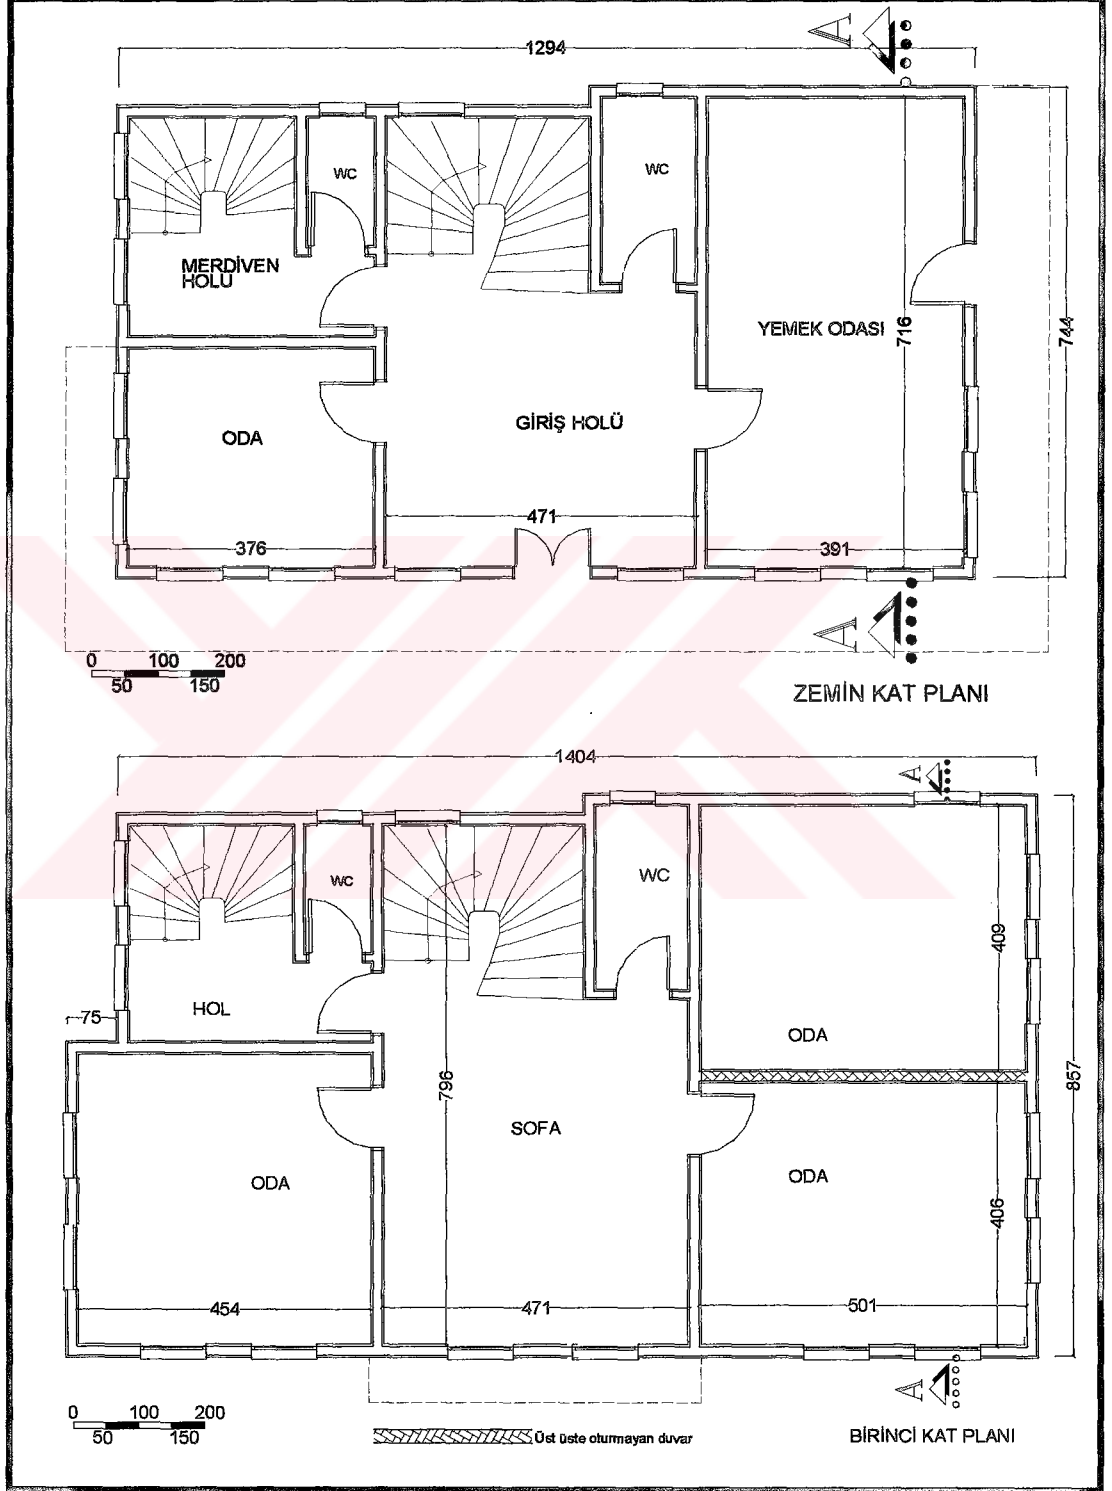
TCDD Sanat Galerisi Zemin Kat Planı
